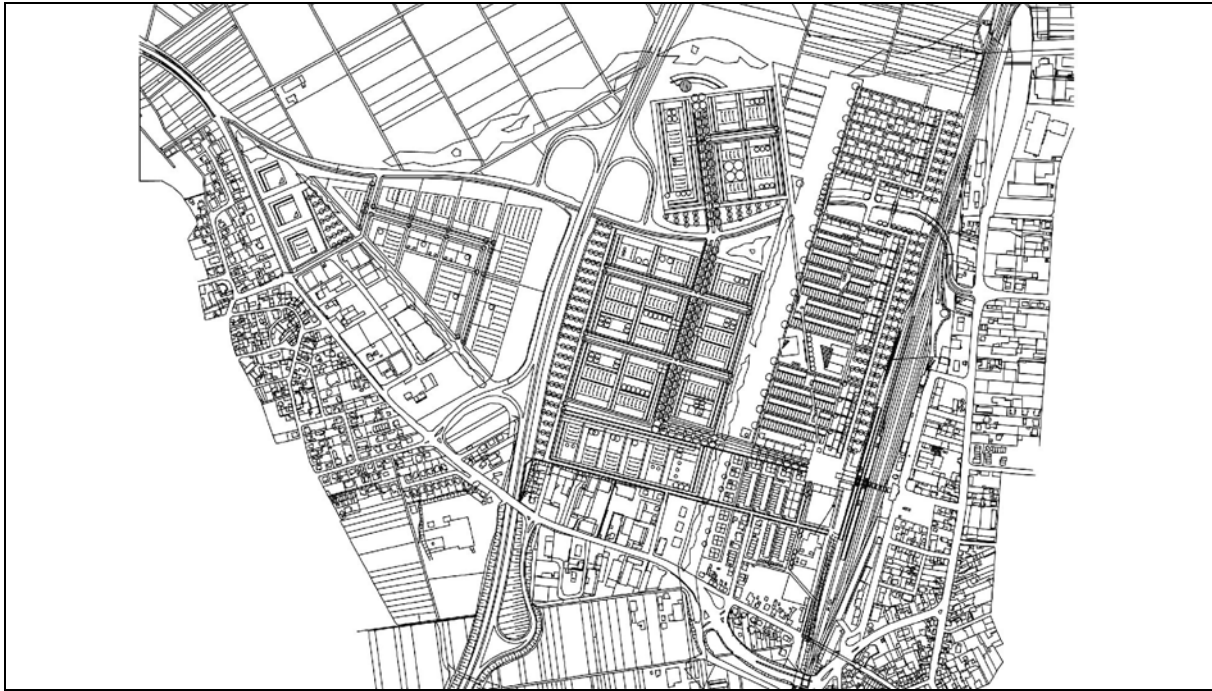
Städtebauliche Ziele der ursprünglichen Planaufstellung
